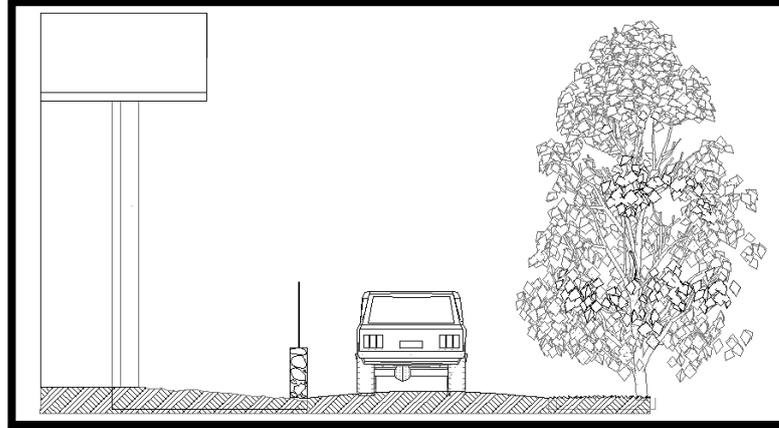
SECCIÓN DE LA CALLE A SECCIÓN – TRAMO (T8 –T11)
